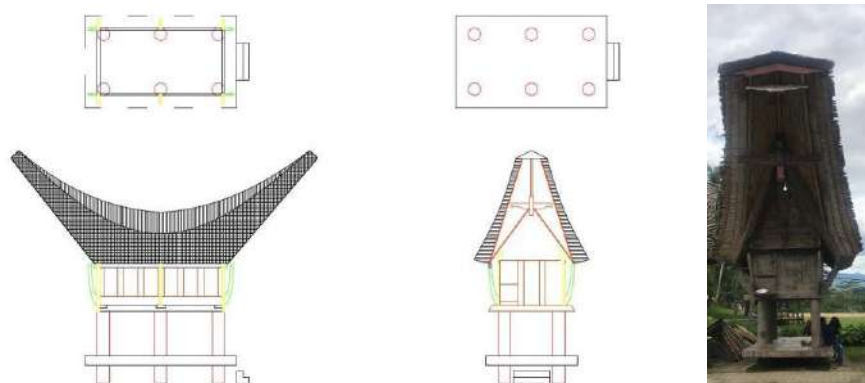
Denah dan Tampak Tongkonan Kete' Kesu
